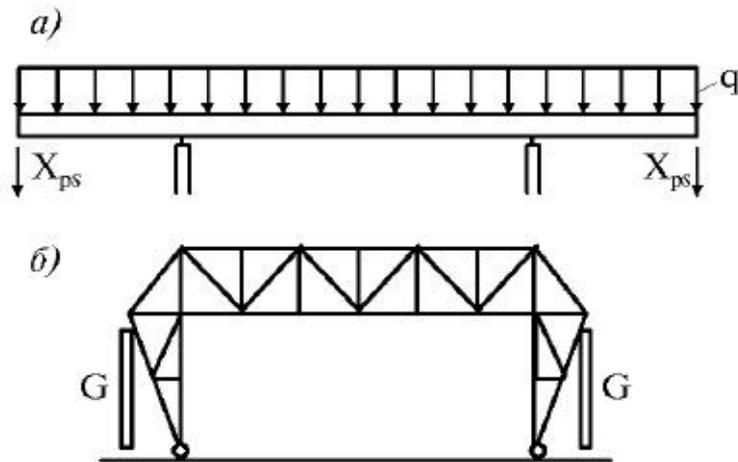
Пригруз (X_{ps}) на консолях и подвеска стен к раме
